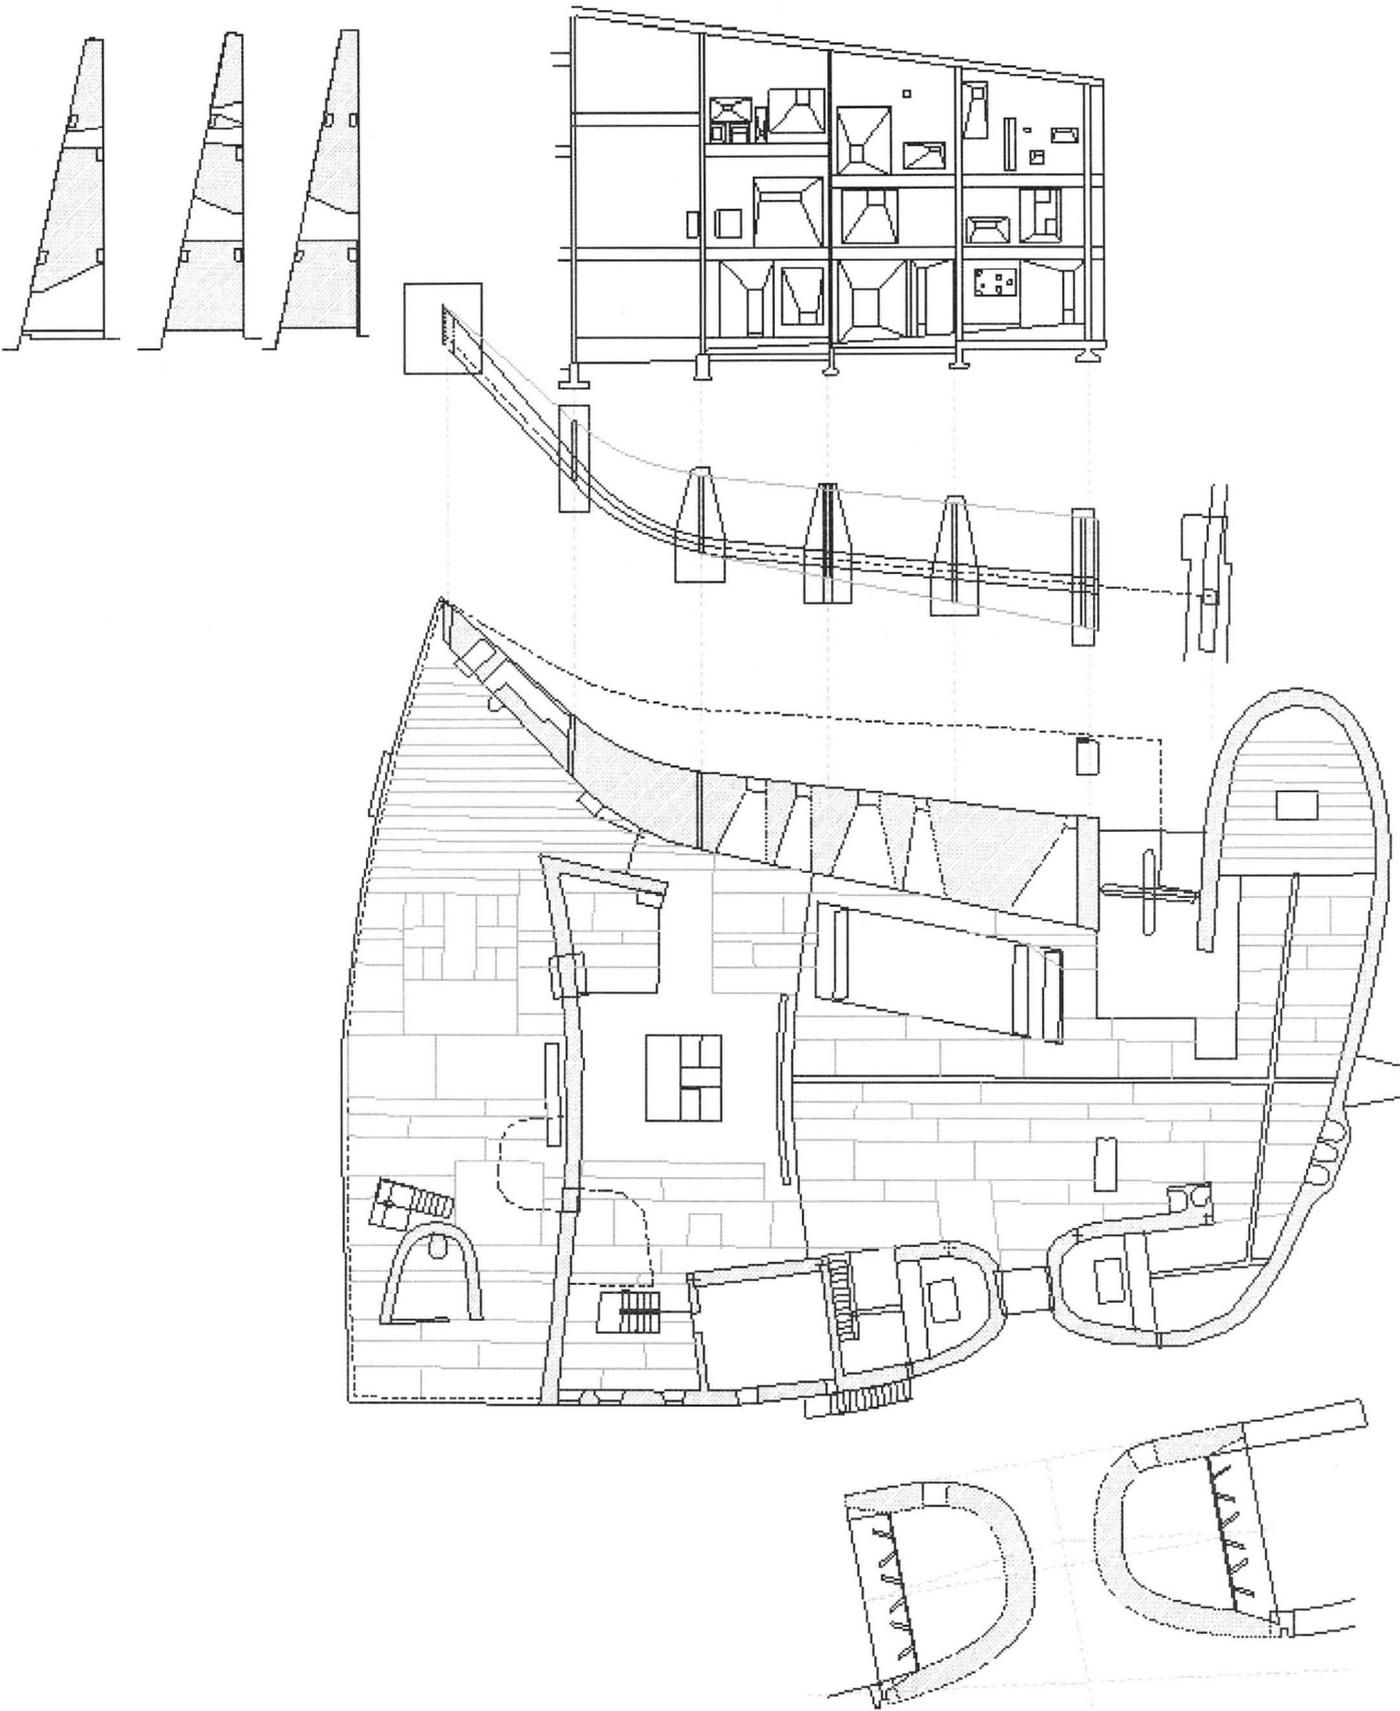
Planta de la capilla de Ronchamp. Estructura del muro sur: planta, alzado y secciones.
